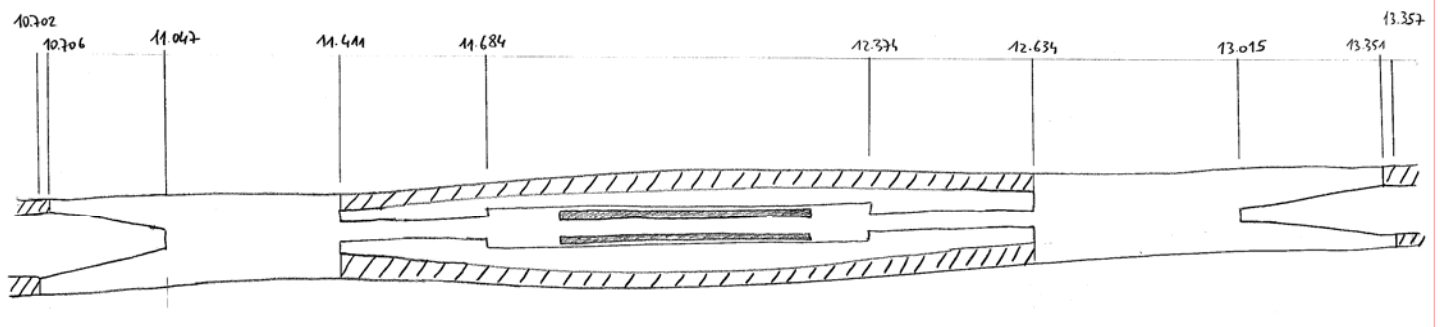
schéma du tunnel au droit de la gare de Monaco
